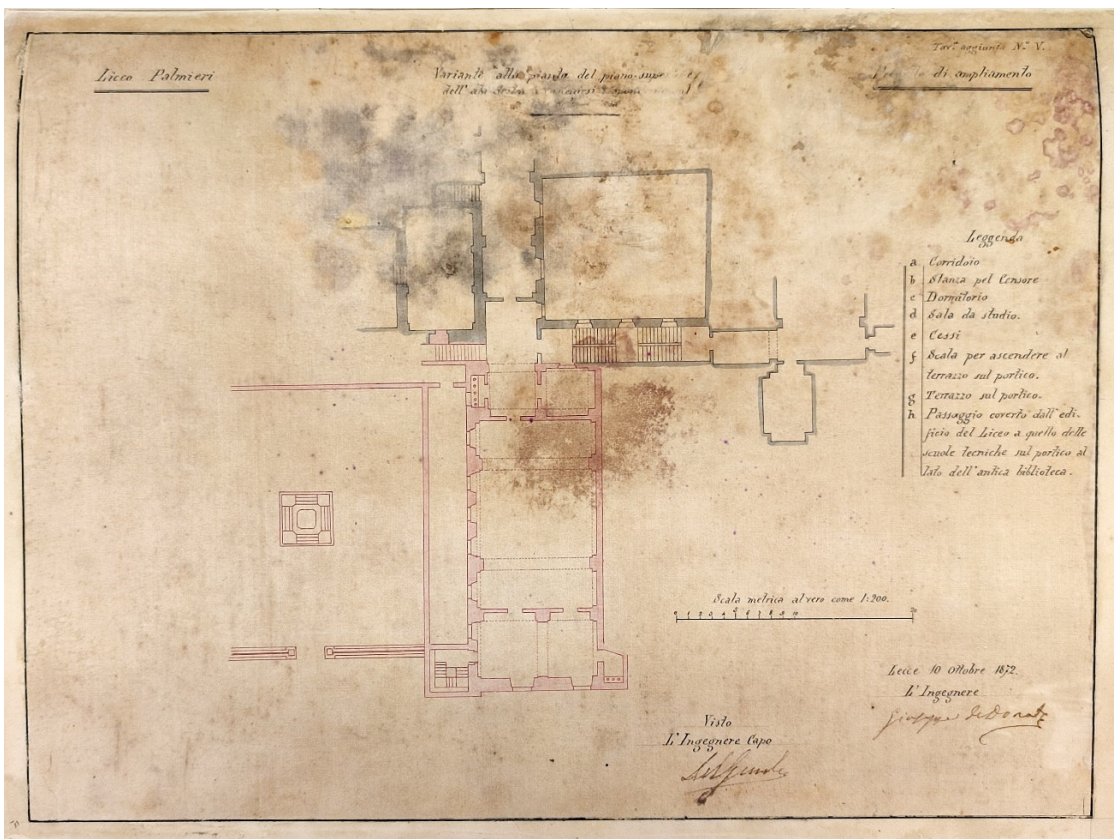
Pianta del primo piano alternativa del progetto di ampliamento del Liceo Palmieri, 1872 (ASL, Provincia di Terra d'Otranto)
